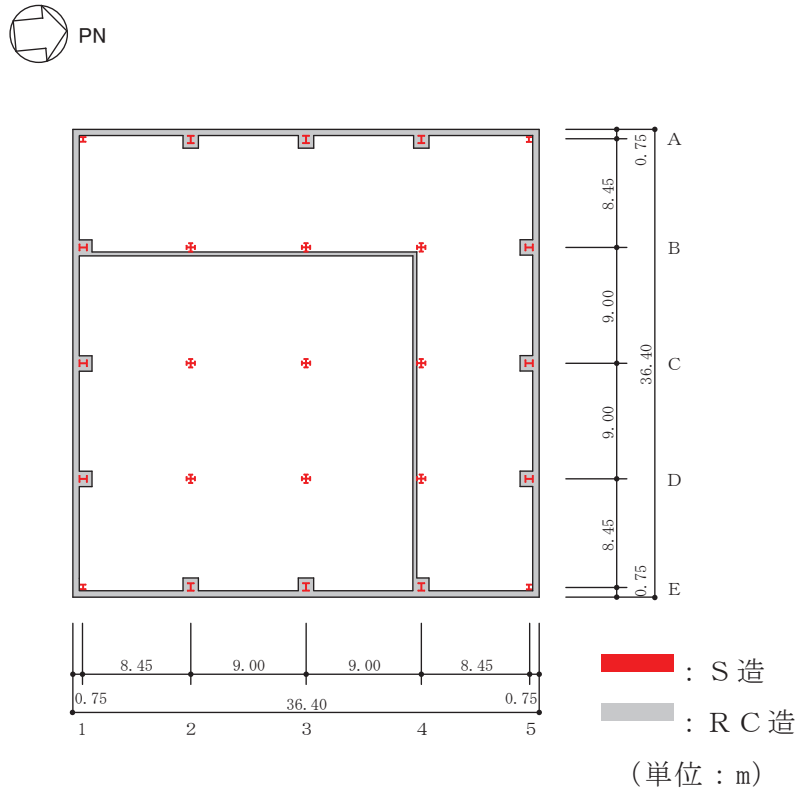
(4) 緊急時対策建屋の概略平面図 (0.P.69.4m)
